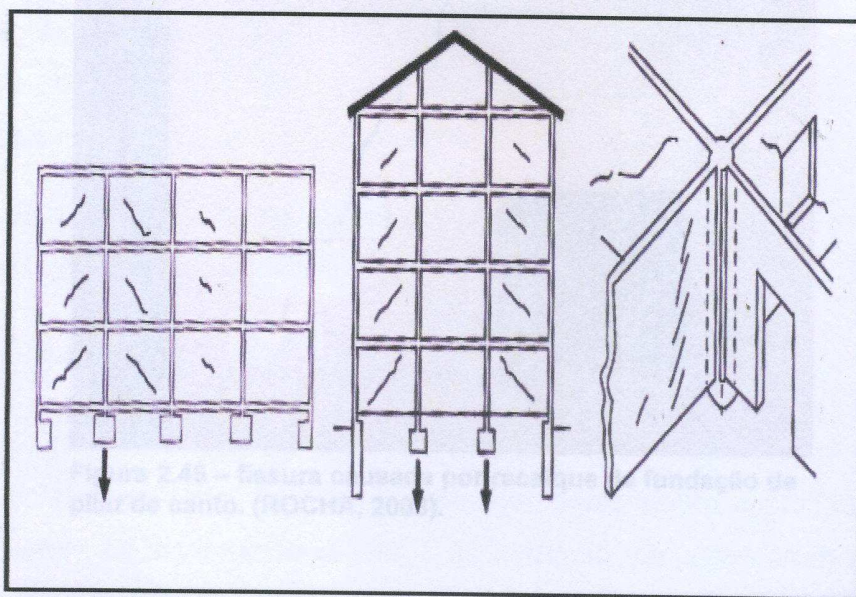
fissuras típicas causadas por recalque de fundação de pilares internos. (ORTIZ, 1984 apud MILITITSKY ET AL, 2008).
